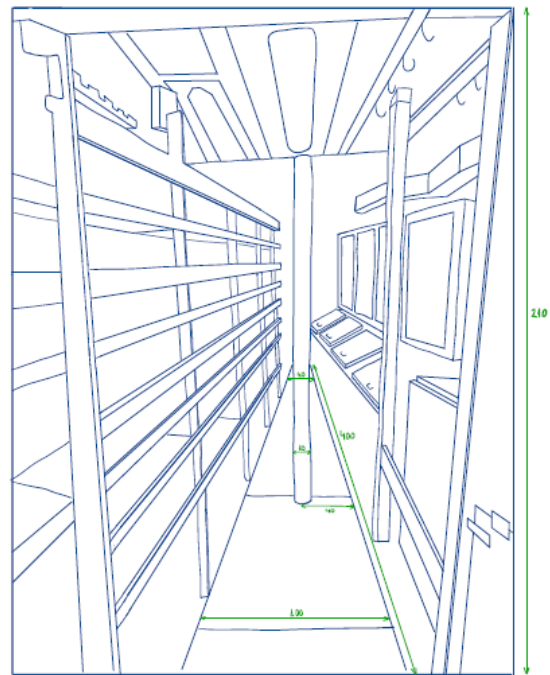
Croqui vista en planta cocina "Tabarca"
